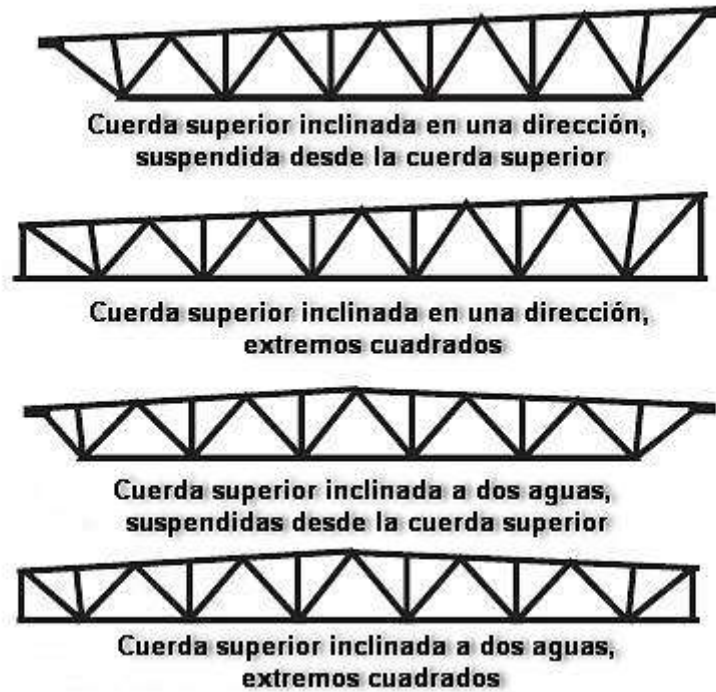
Ejemplos de vigas de alma abierta de acuerdo a su inclinación.
